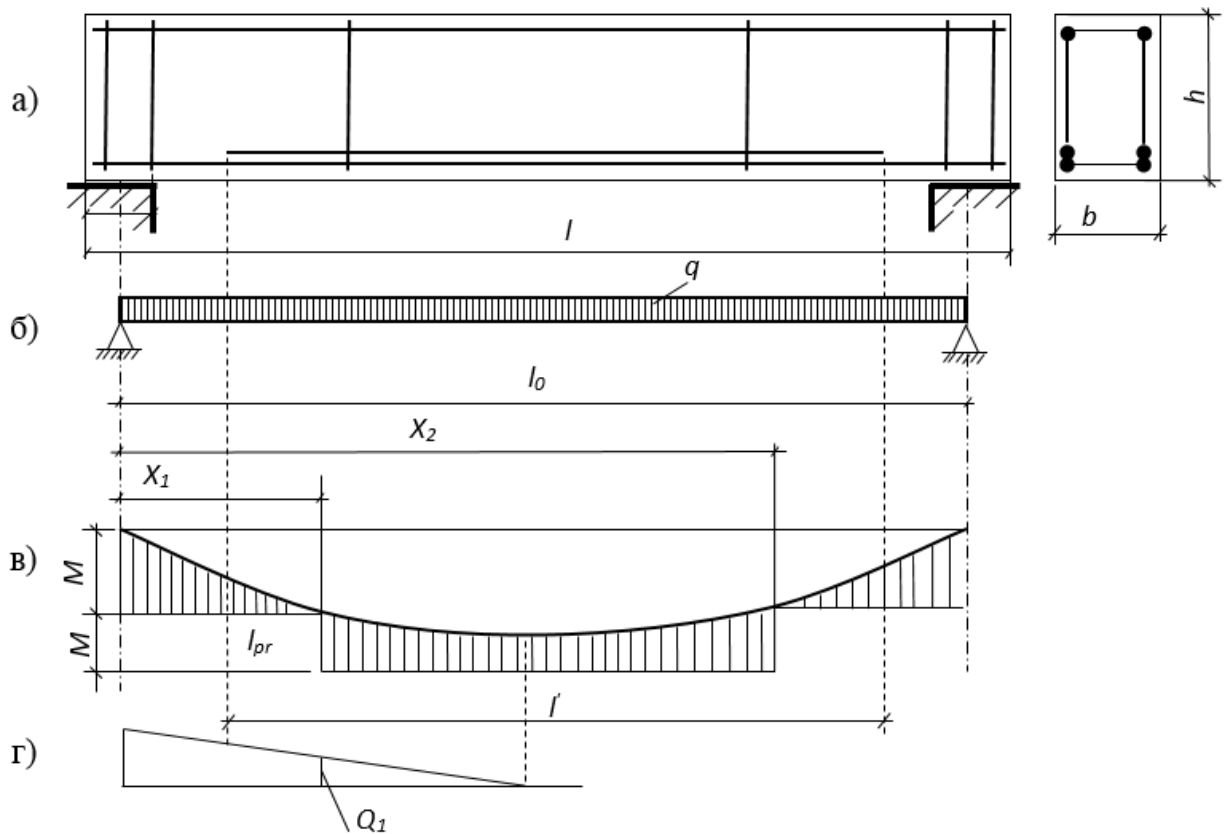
Побудова епюри балки: а – схема армування, б – розрахункова схема, в – епюра арматури, г – епюра поперечних сил
